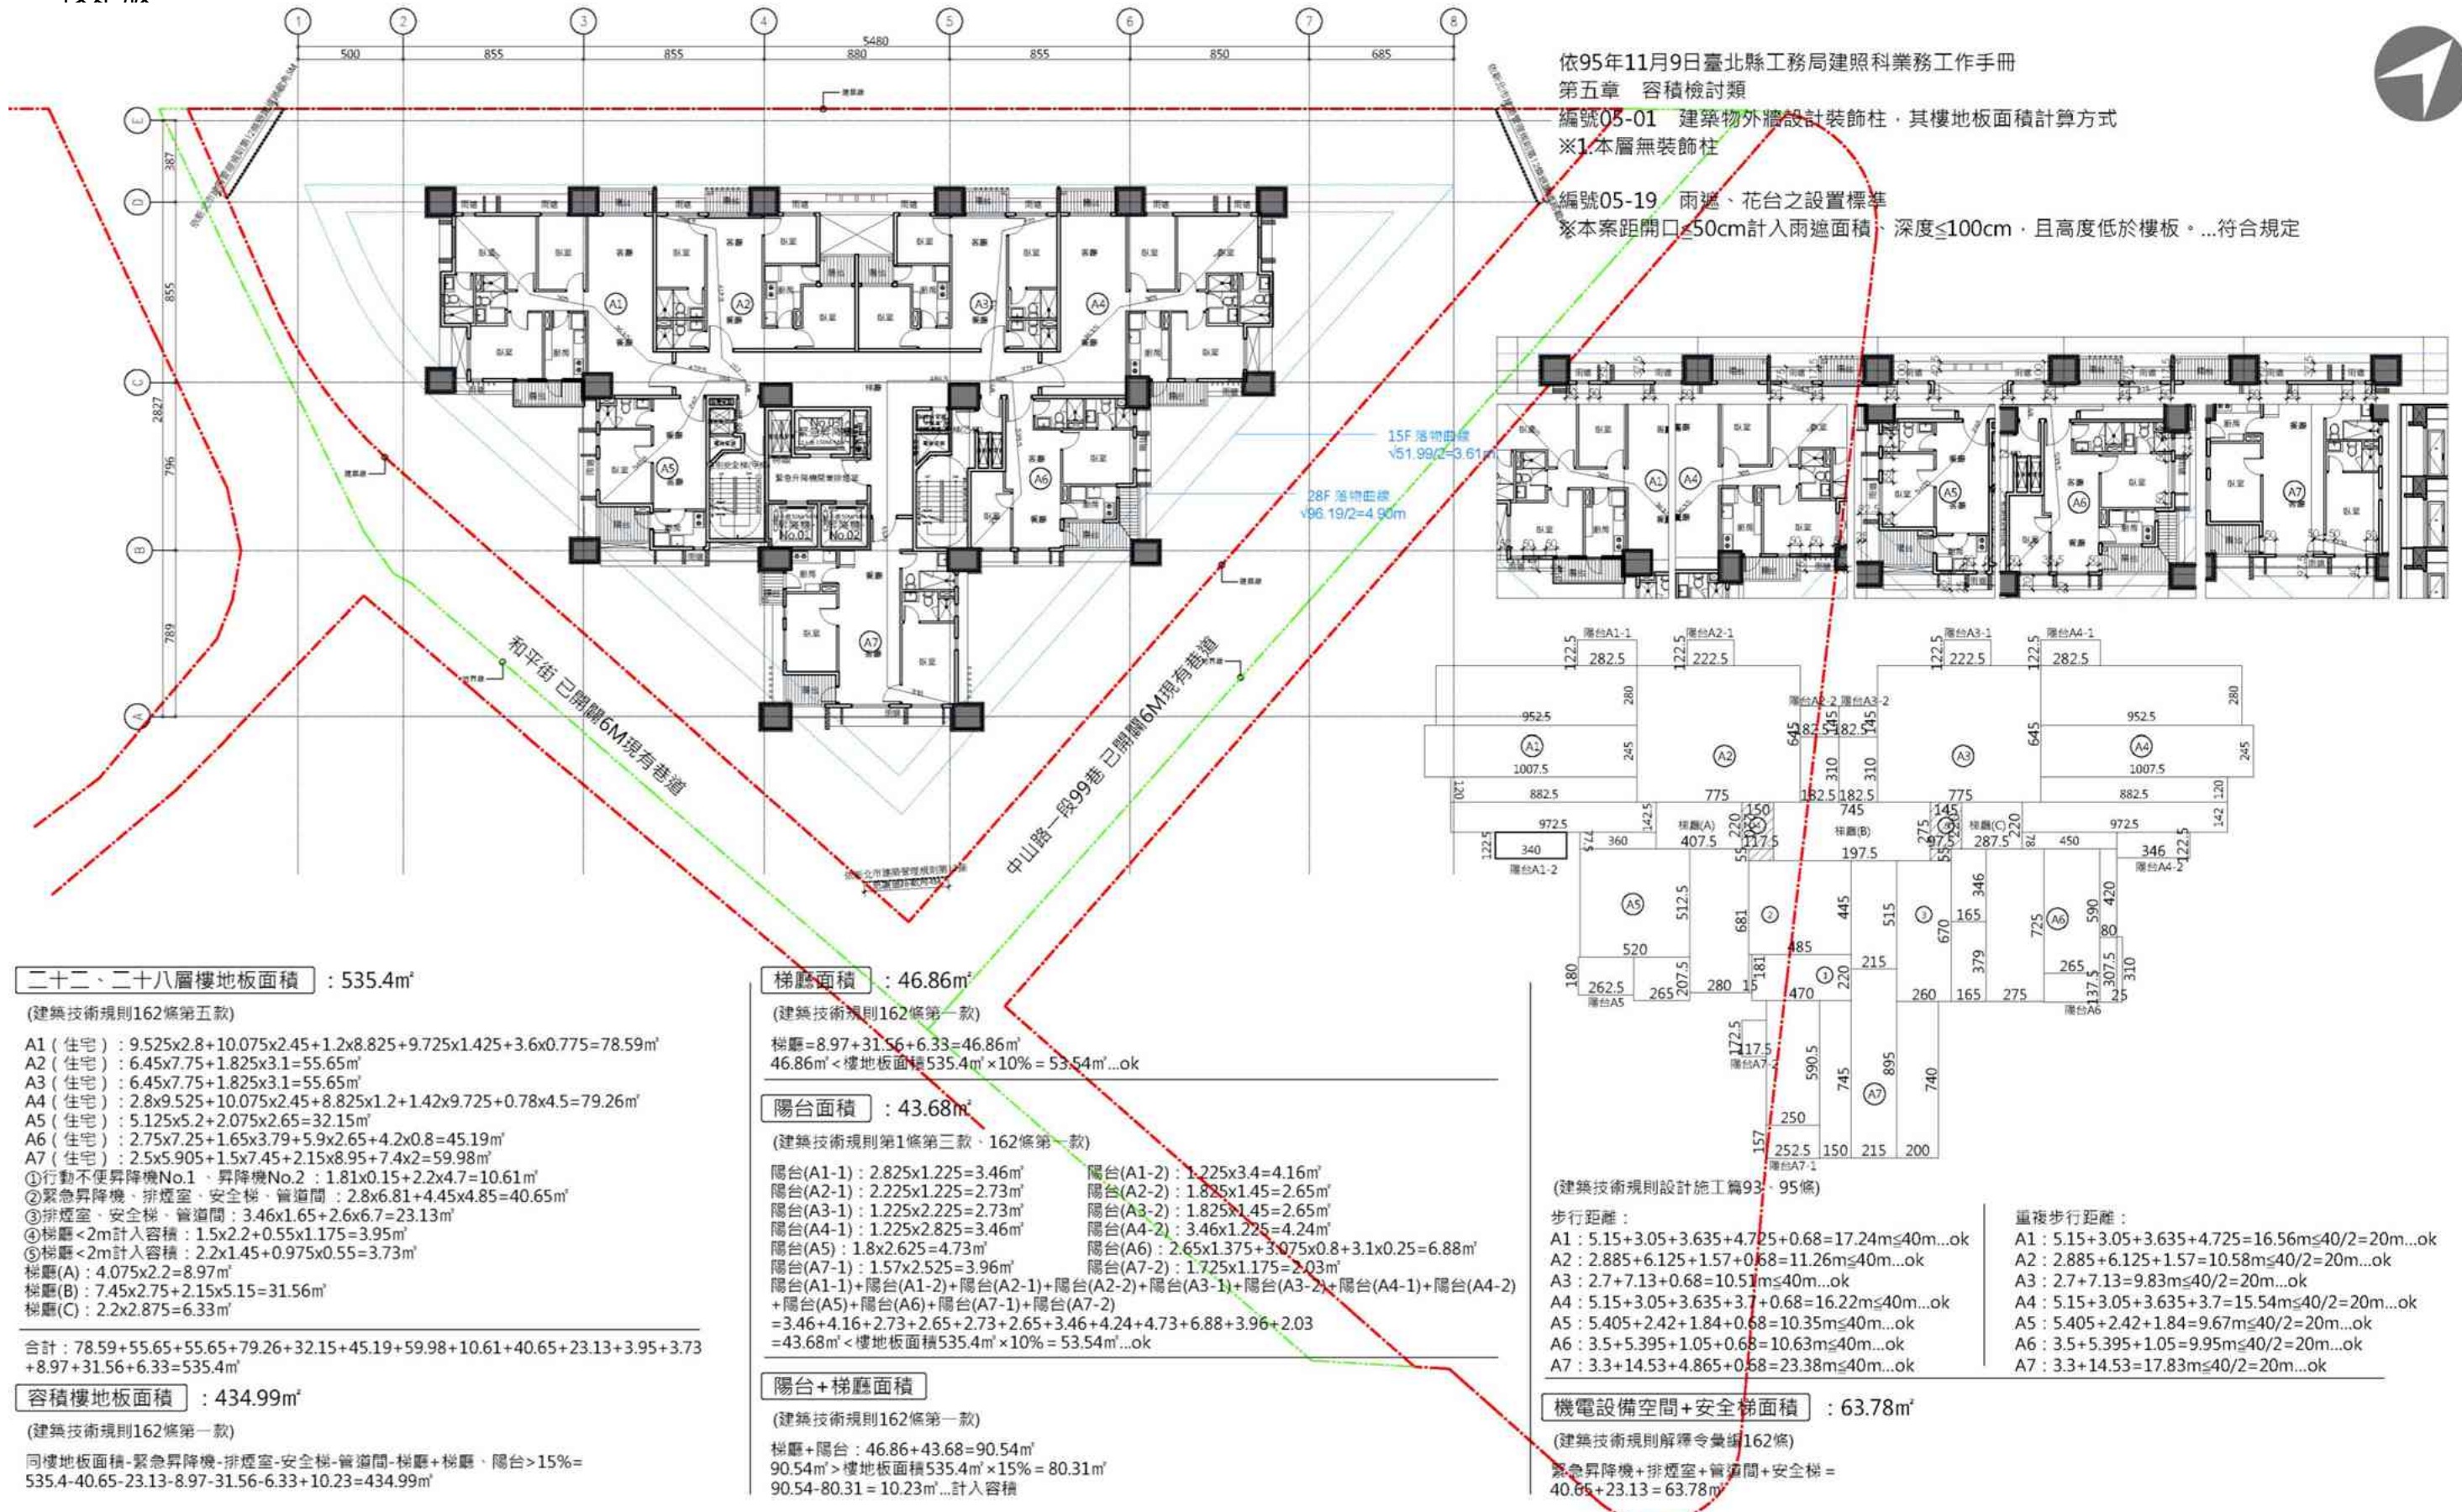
21、27F 平面圖；SCALE A3=1/300
